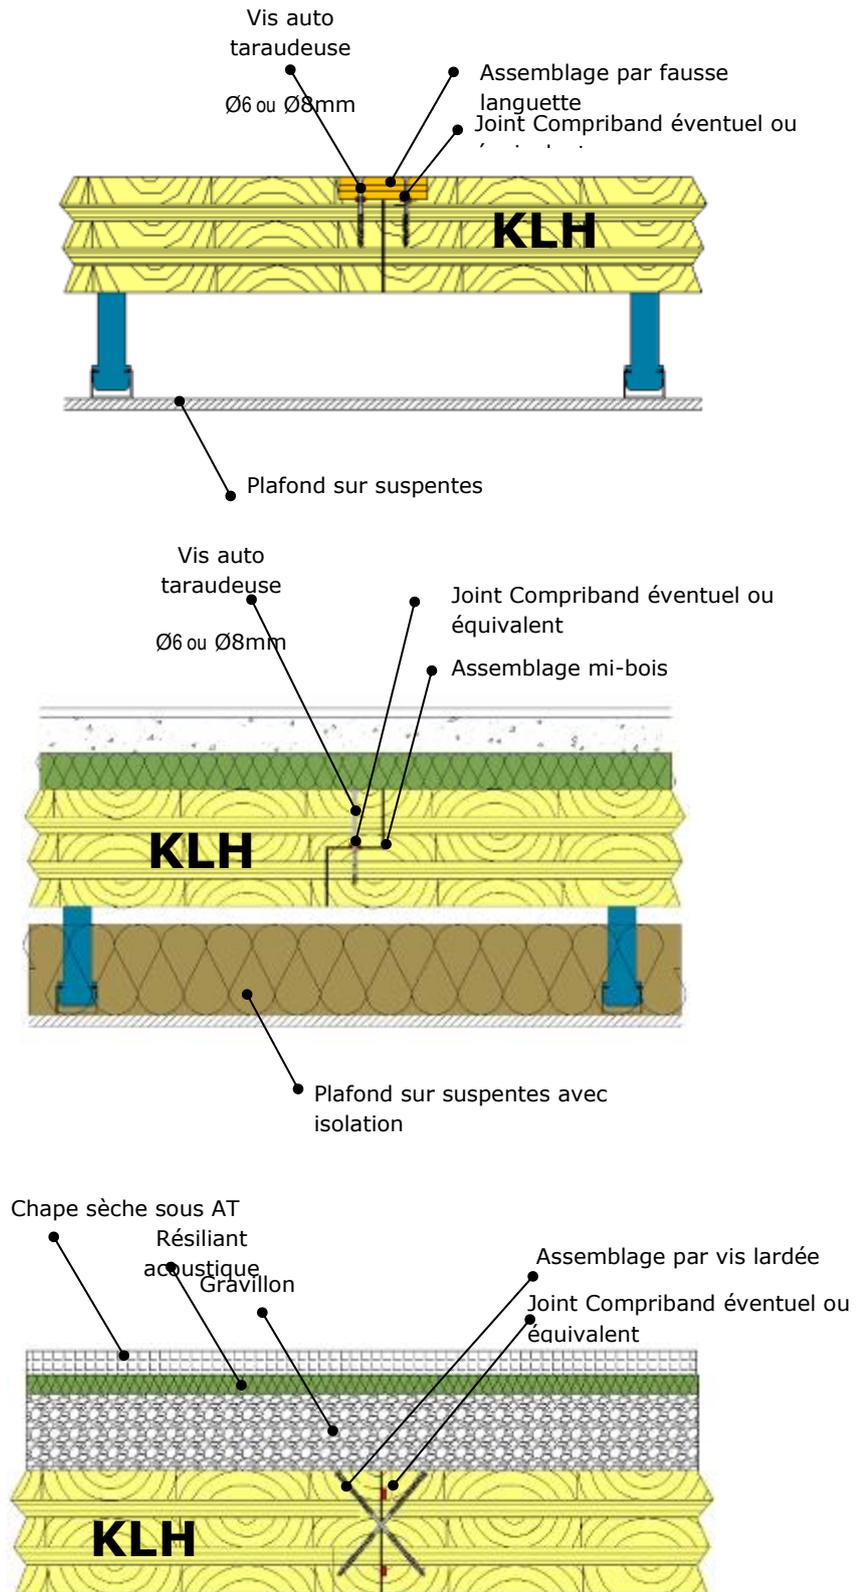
Coupe verticales jonction usuelles de planchers ou de murs
